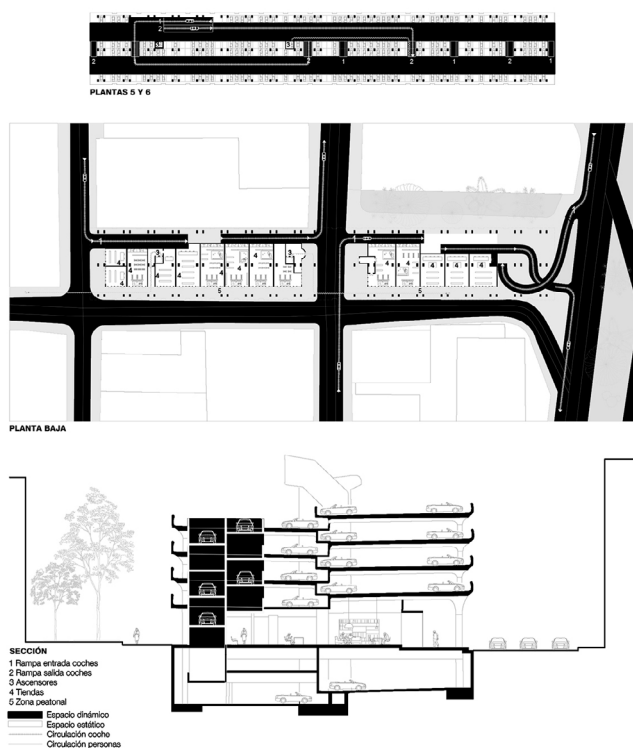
Planta y sección del Temple Street Garage, Connecticut, Paul Rudolph, 1963. (Dibujo del autor)
